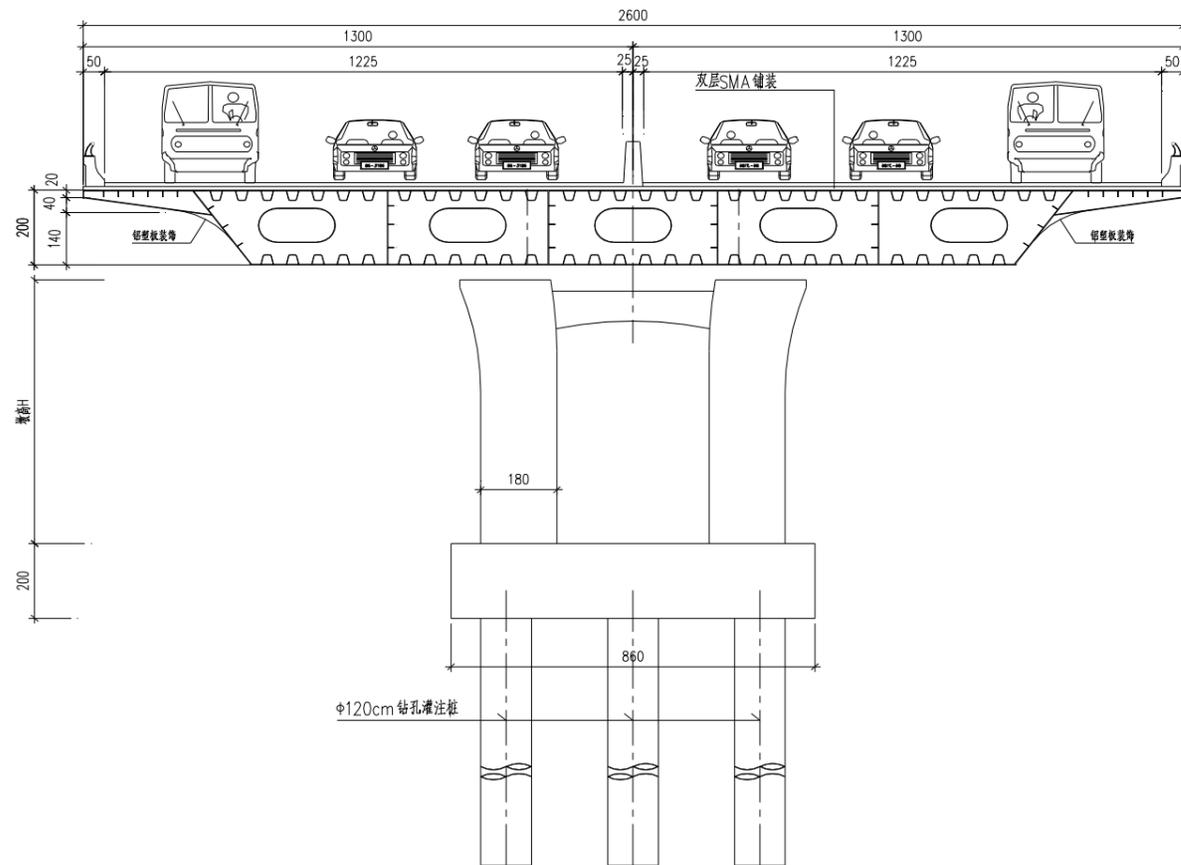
高架断面示意图（钢箱梁）（尺寸单位：cm）
